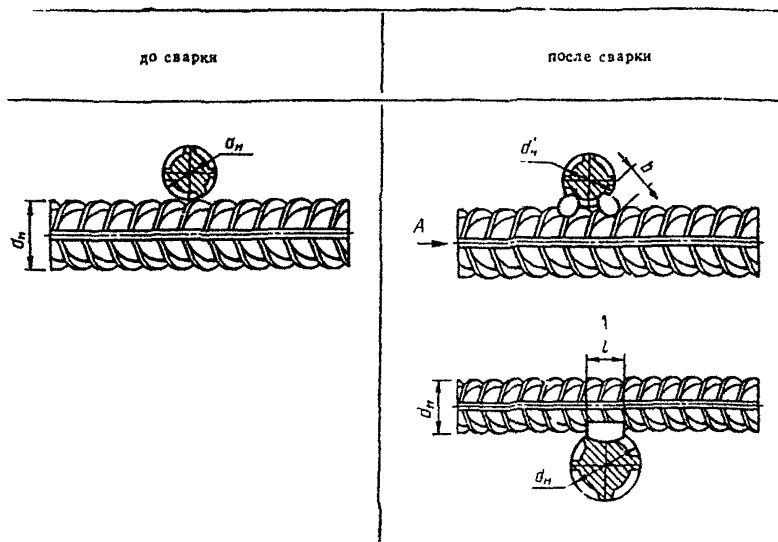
Конструкция крестообразного соединения арматуры типа КЗ-Фр
